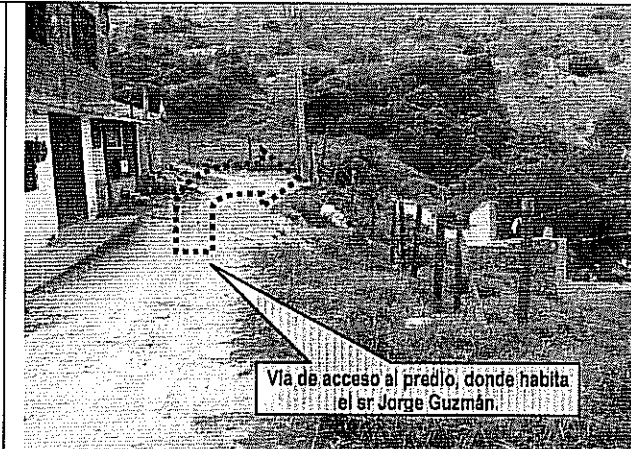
Evidencia de la vía Diagonal 68A Sur, ruta de acceso a la vivienda objeto de evaluación donde habita el Sr Jorge Guzmán.
